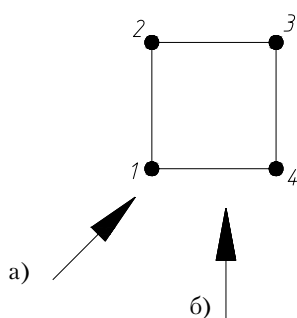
Схема наиболее опасных направлений ветра: а) при расчете поясов; б) при расчете решетки.
